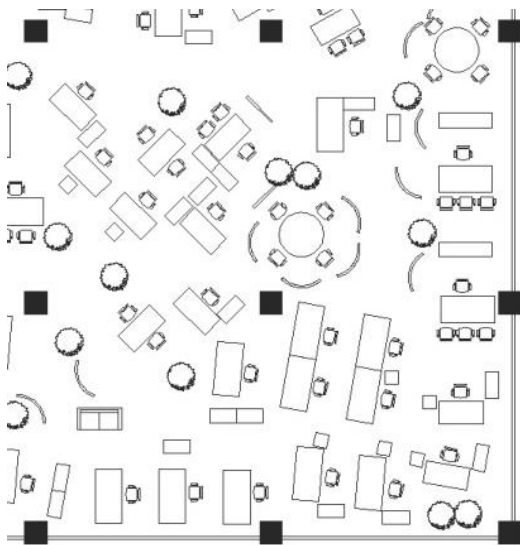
Grundriss einer Bürolandschaft.
